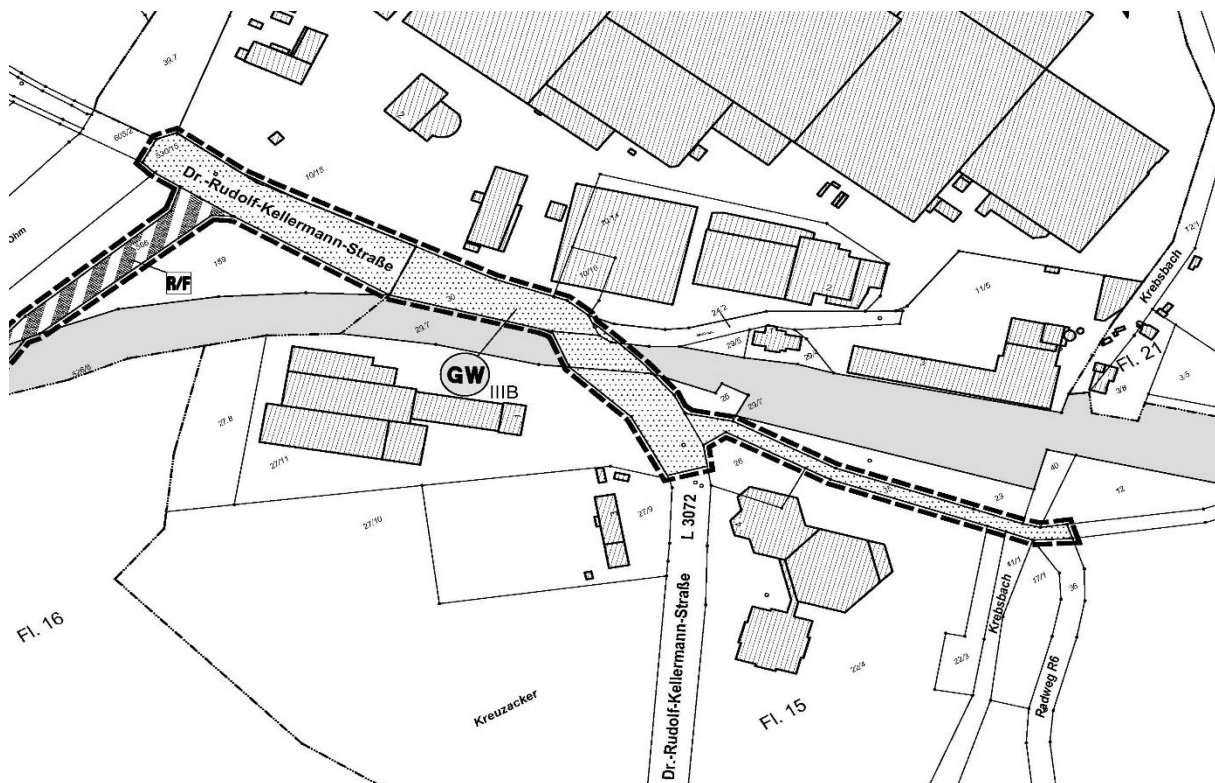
Auszug aus Bebauungsplan „Radweg auf ehemaliger Bahntrasse, Ober-Ofleiden bis einschl. Brücke Krebsbach“
